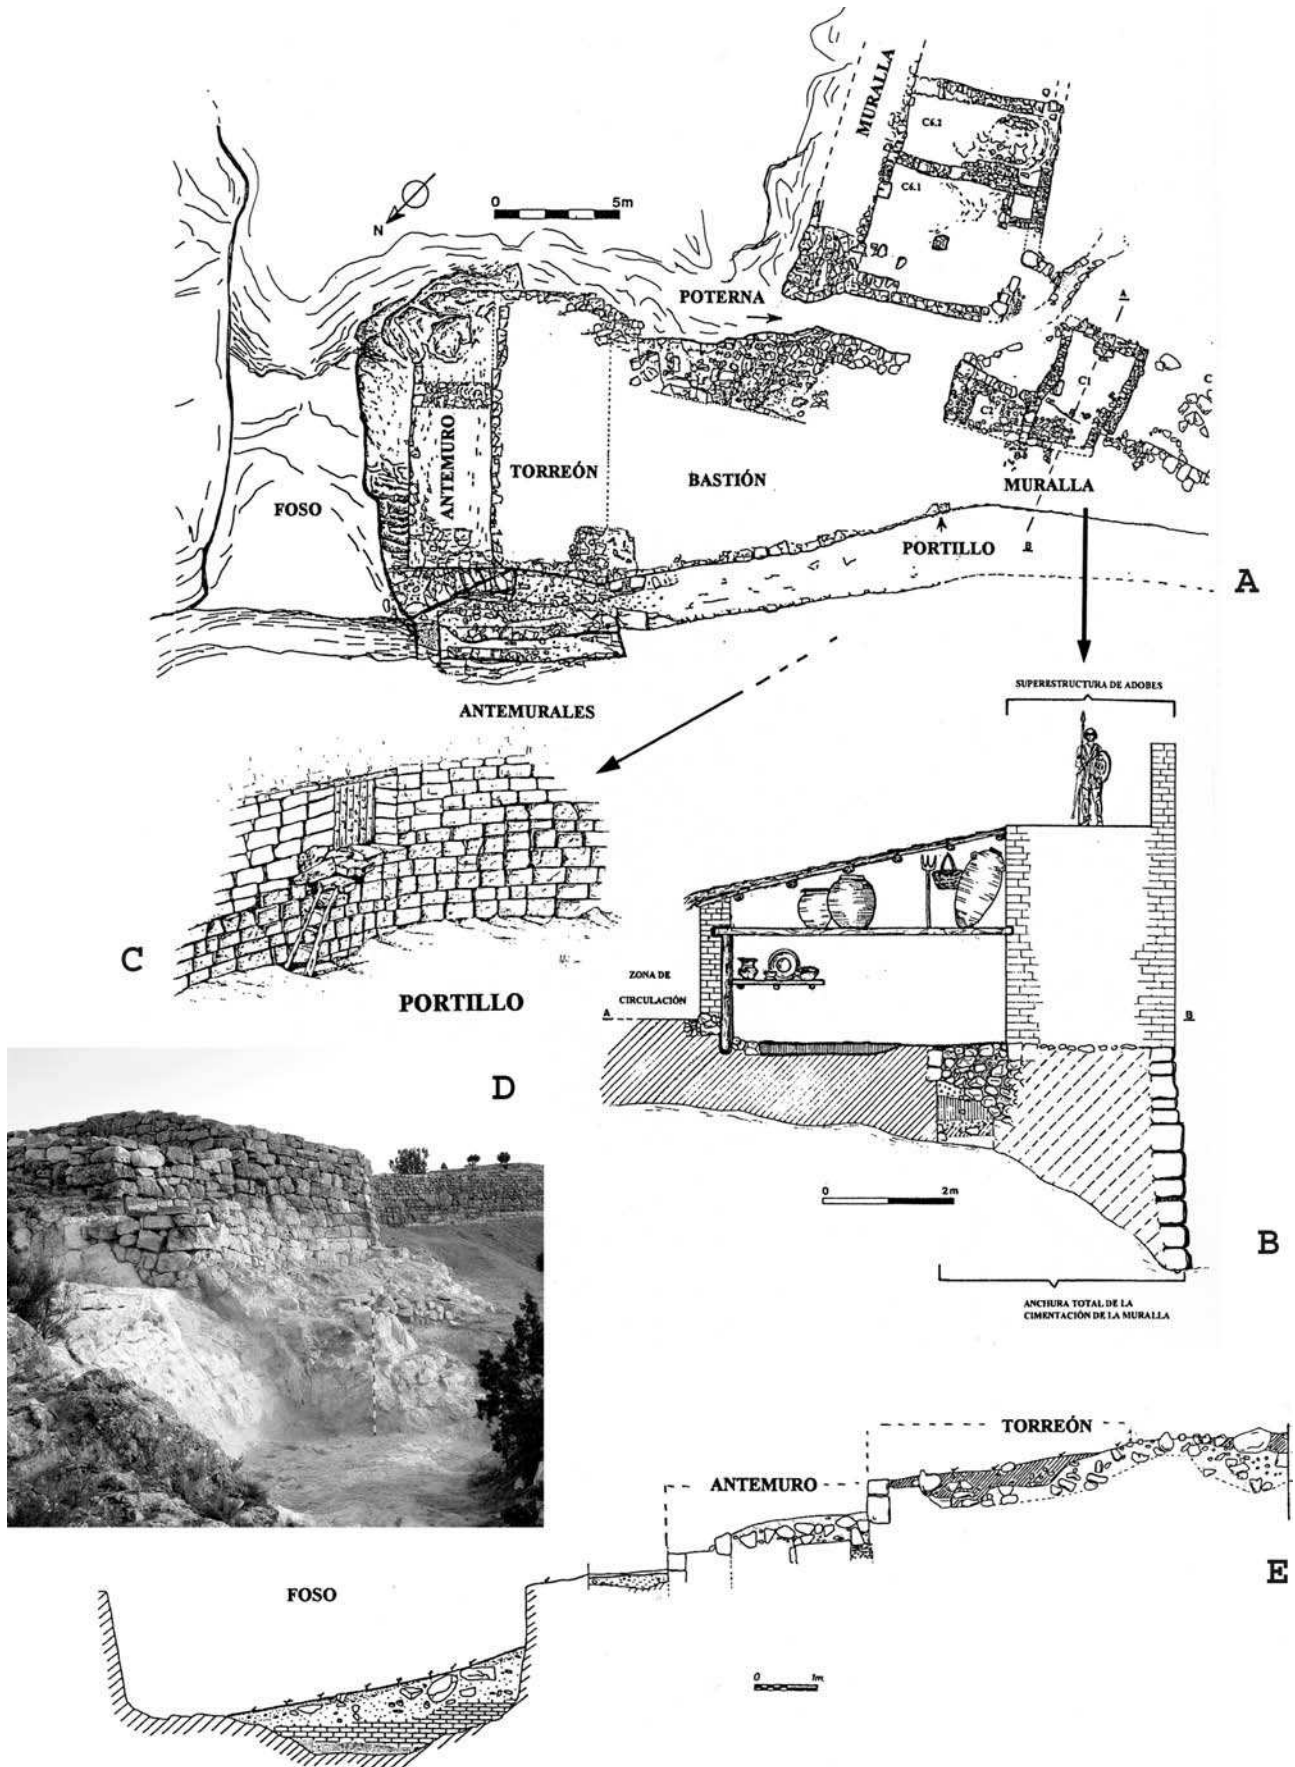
A, planta del sector oriental del poblado y del sistema defensivo del istmo; B, propuesta de reconstrucción de la estancia C1, en su fase más avanzada (ca. siglos II-I a.C.), y del sistema constructivo de la muralla norte; C, propuesta de reconstrucción del portillo. D, vista de las defensas orientales desde el foso. E, sección E-W de las defensas.(B, según Lorrio, 2001b).
